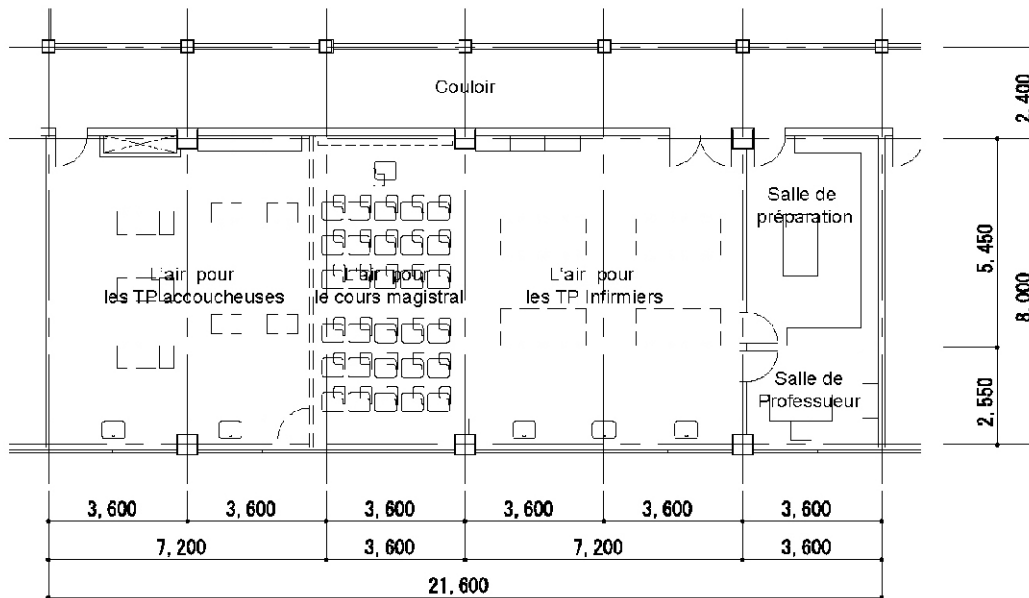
Plan de masse de la salle de TP Infirmiers et accoucheuses
